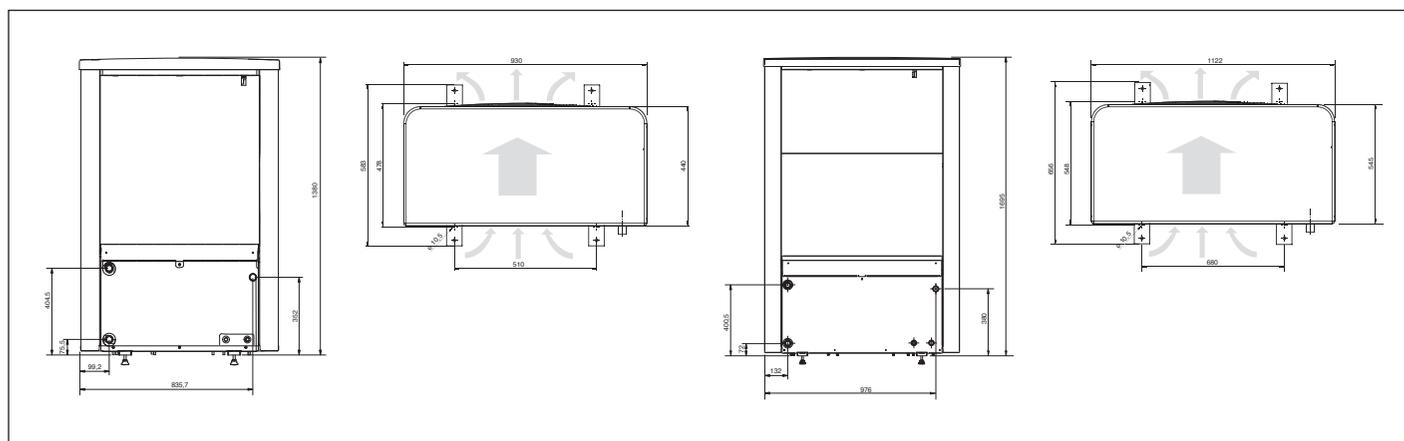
Dimensioni e collegamento unità esterna Compress 7000 AW (si veda anche Tab. 8)
